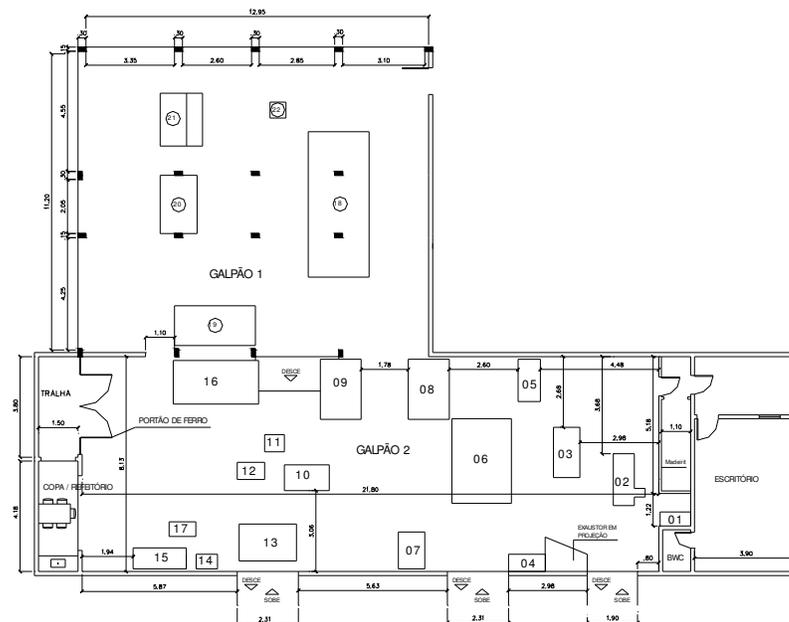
Planta baixa 2: Galpão 1 e 2 com lay-out modificado com a linha de produtos sob encomenda. (Equipe de Projeto).
